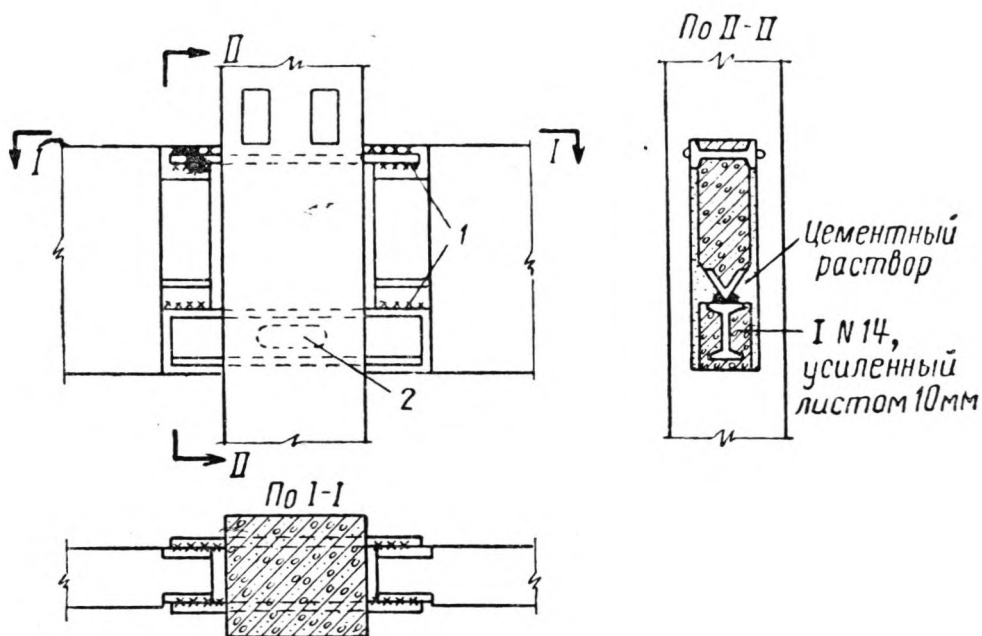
Узел сопряжения ригеля со стойкой каркаса при помощи двутавра (из нормалей для московских заводов железобетонных изделий)
